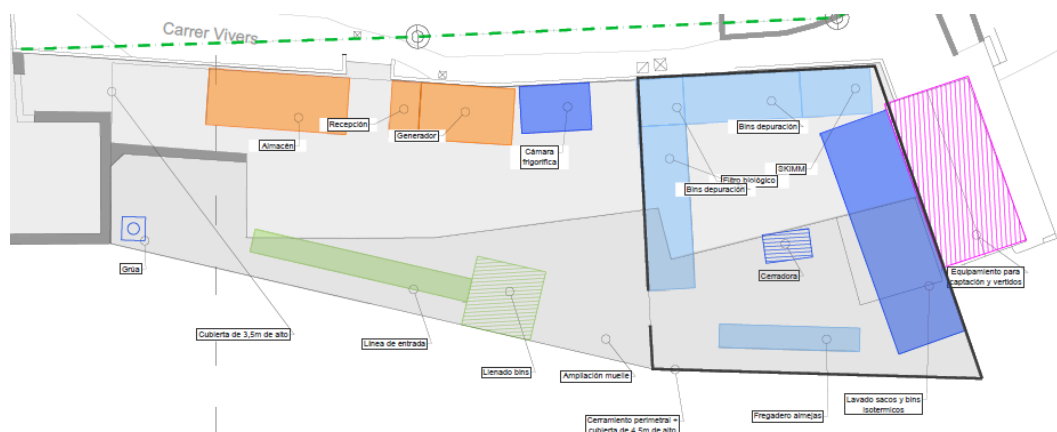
Planta propuesta para la alternativa 4 en las parcelas 8, 9 y 10.
